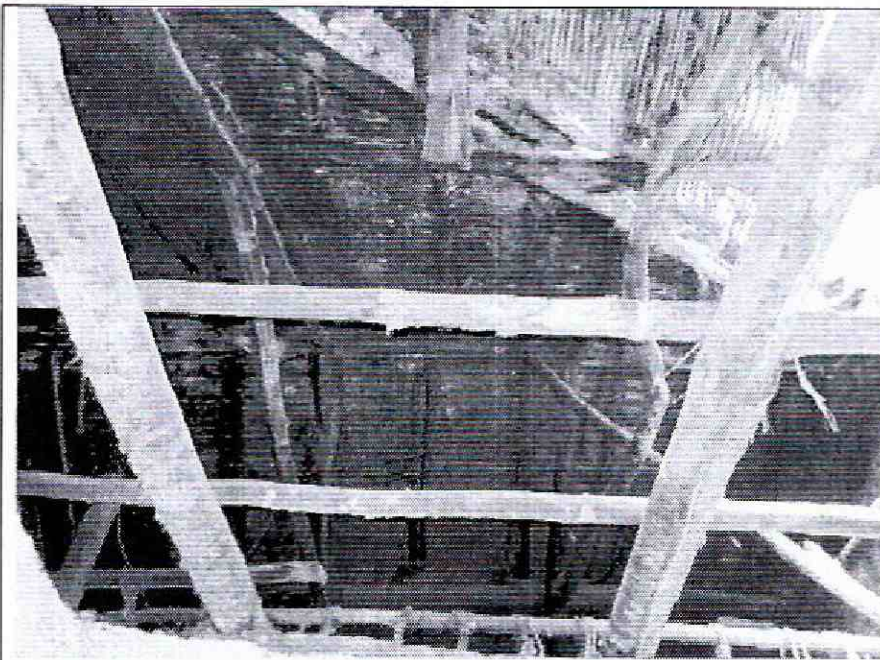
Deterioro fuerte de los elementos de la cubierta.
